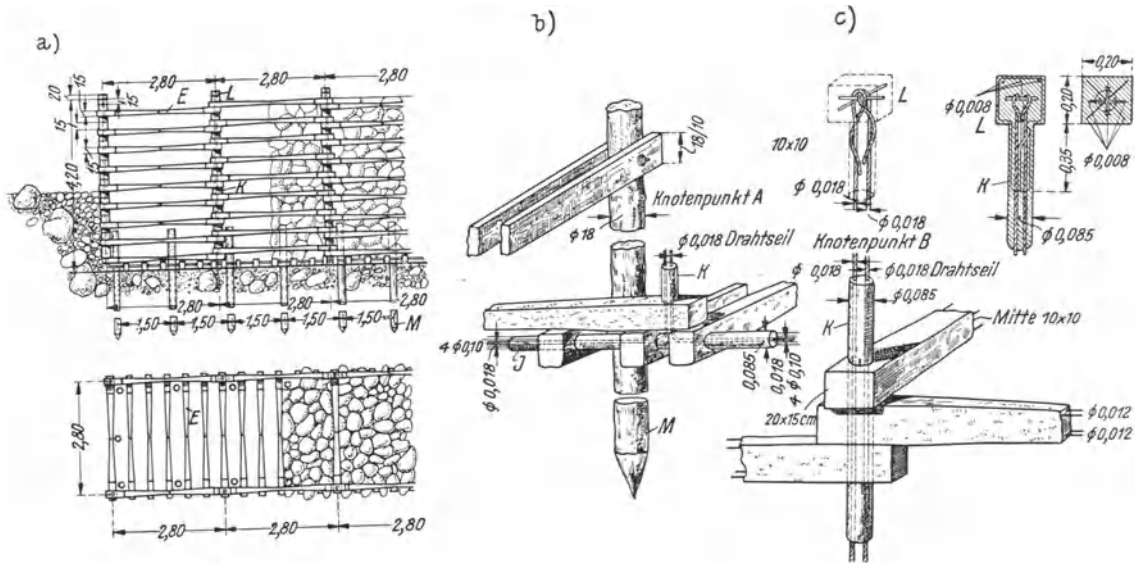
Steinkasten aus Eisenbeton, Bauart Andreocci.
